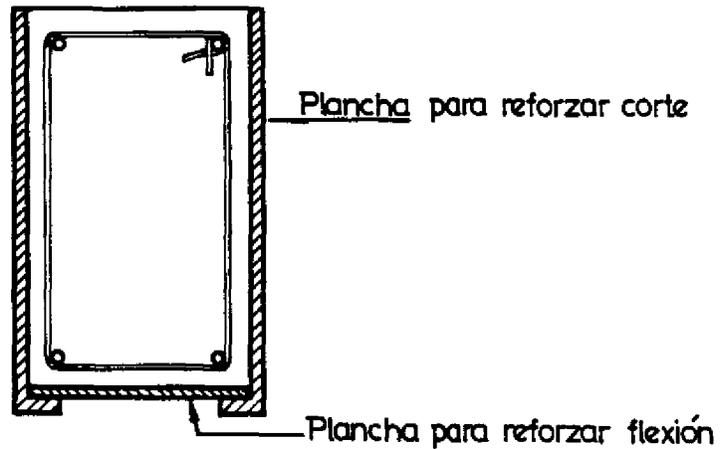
Caso V-5. REFUERZO EXTERIOR DE UNA VIGA, CON PLATABANDAS DE ACERO ADHERIDAS CON RESINA EPOXICA
